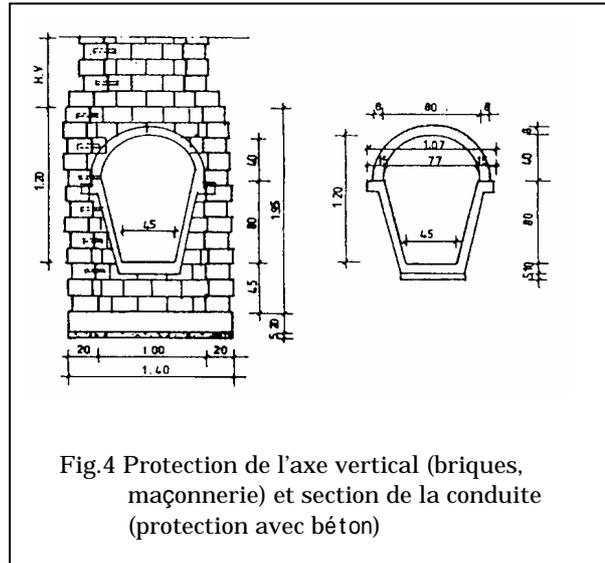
Protection de l'axe vertical (briques, maçonnerie) et section de la conduite (protection avec béton)
